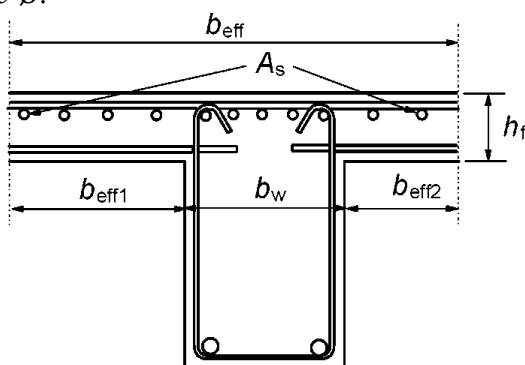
Расположение растянутой арматуры в сечении полки неразрезных балок
